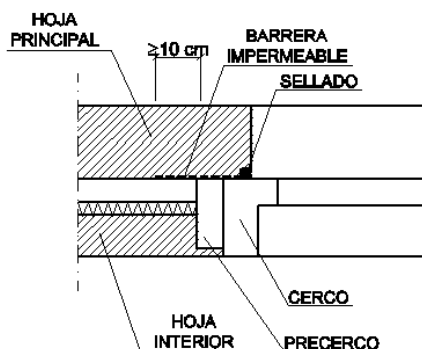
Ejemplo de encuentro de la fachada con la carpinter  a
